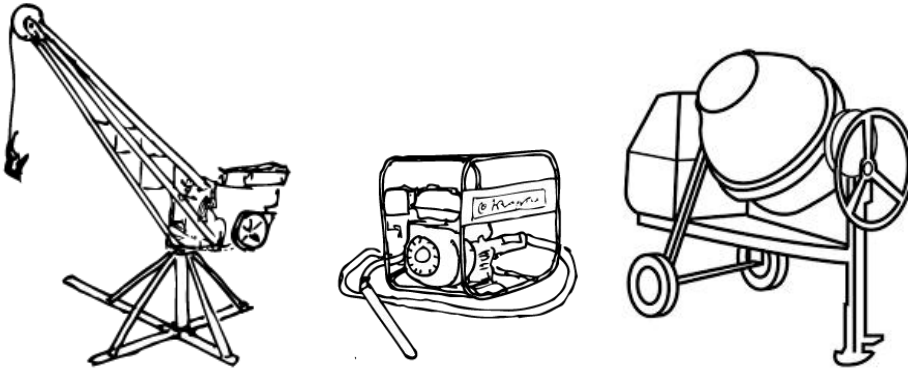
Equipo para fundición de losa de hormigón (Elevador, vibrador, concretara)
